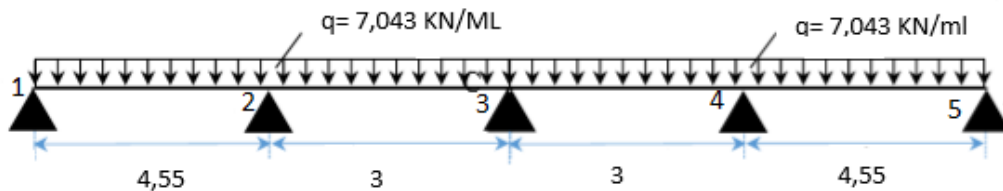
coupe transversale de la poutrelle à 4 travées.
